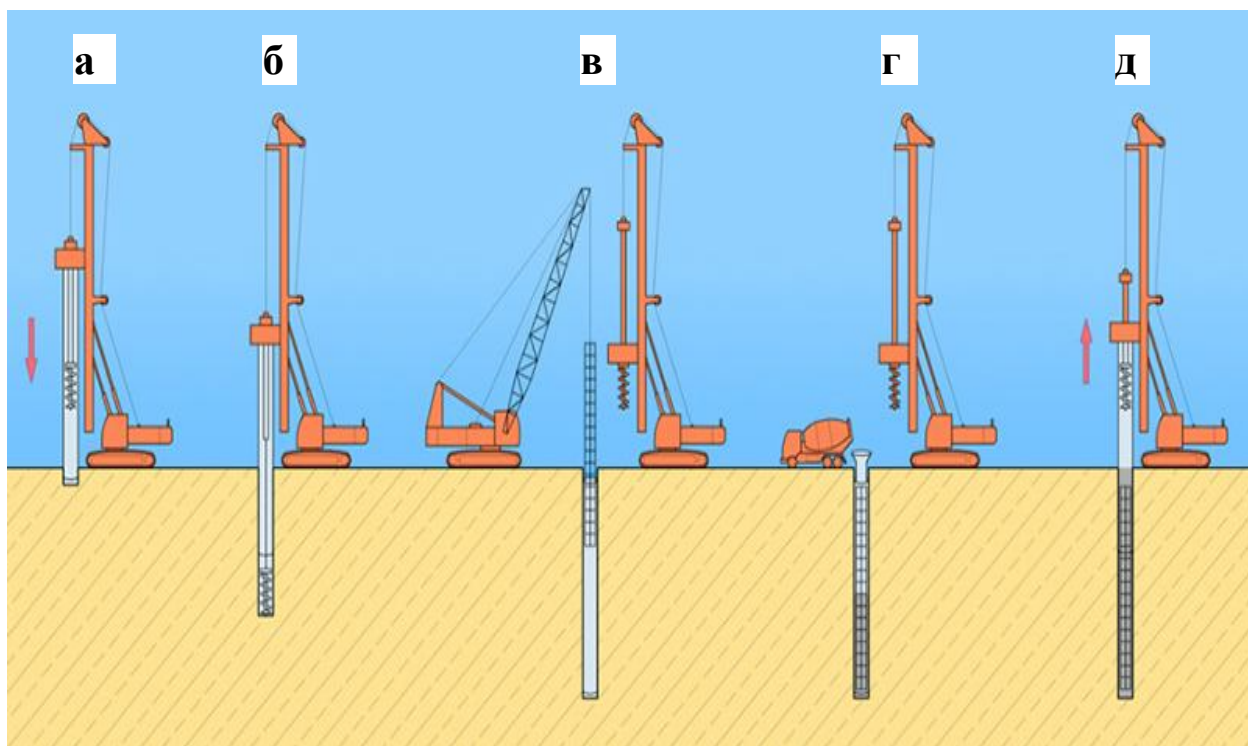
Бурунабивні палі: а – занурення колони обсадних труб у ґрунт; б – виймання ґрунту з обсадної колони; в – занурення армокаркасу в свердловину; г – заповнення свердловини бетоном; д – витягування обсадних труб
